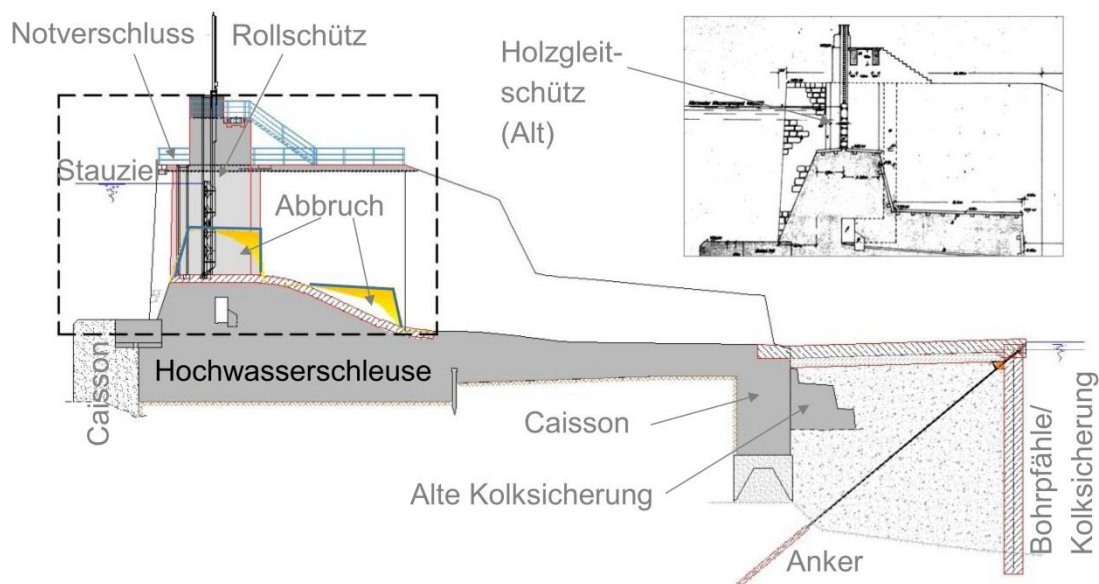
Querschnitt Hochwasserschleuse mit Absenkung und neuem Verschluss
